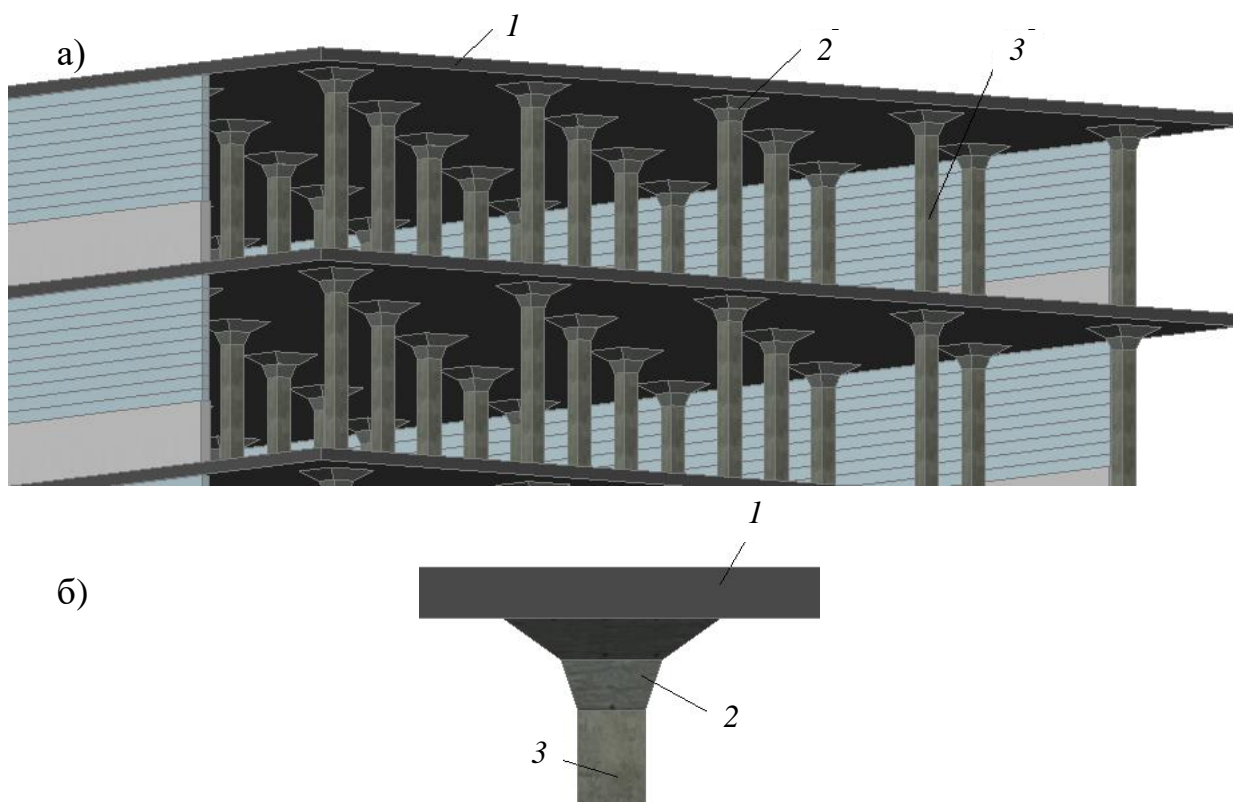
Залізобетонне монолітне безбалкове перекриття:
